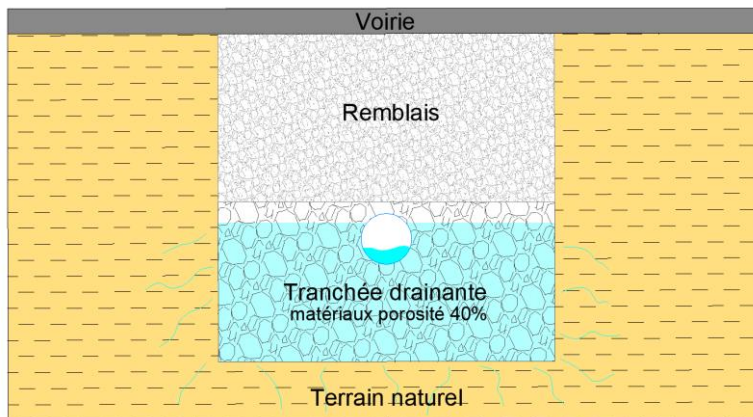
Coupe type de l'ouvrage de tranchée drainante
